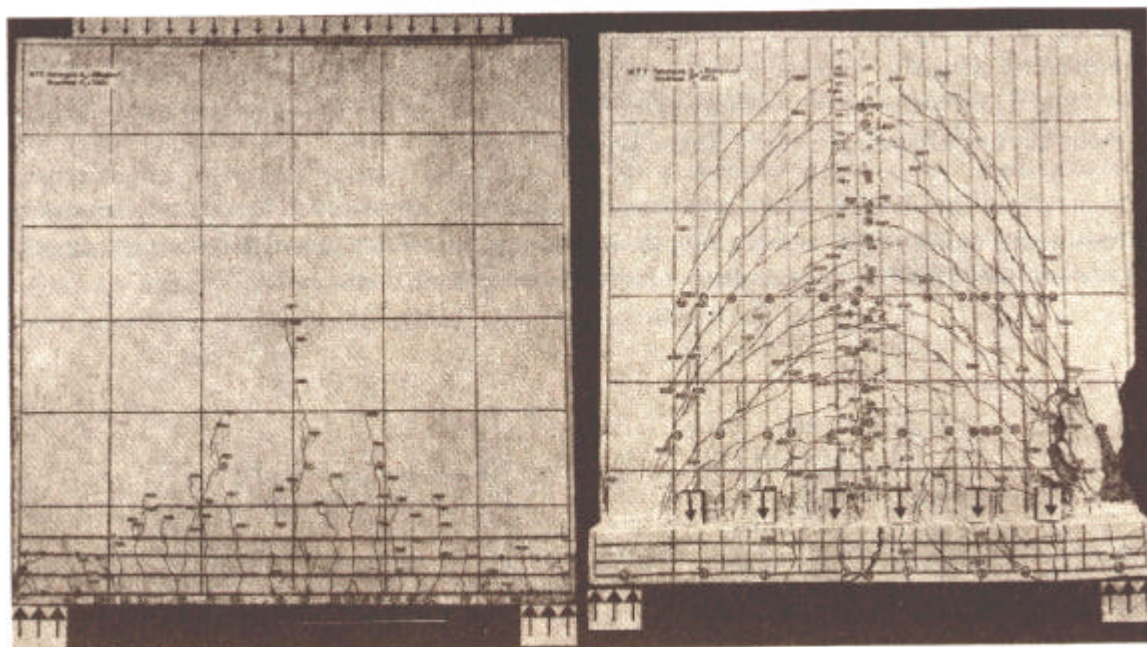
Configuração fissurada de uma viga-parede, próximo à ruptura, sujeita a dois tipos de carregamento (LEONHARDT,1979).
